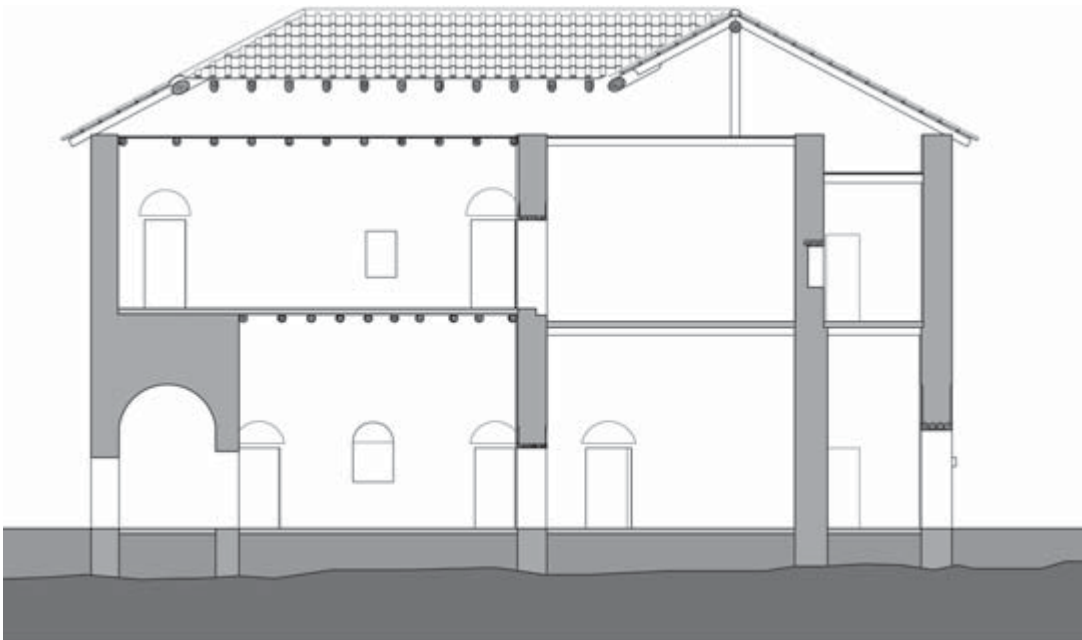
Kirse Yanı, Rekonstruktion, Längsschnitt LL nach Norden
